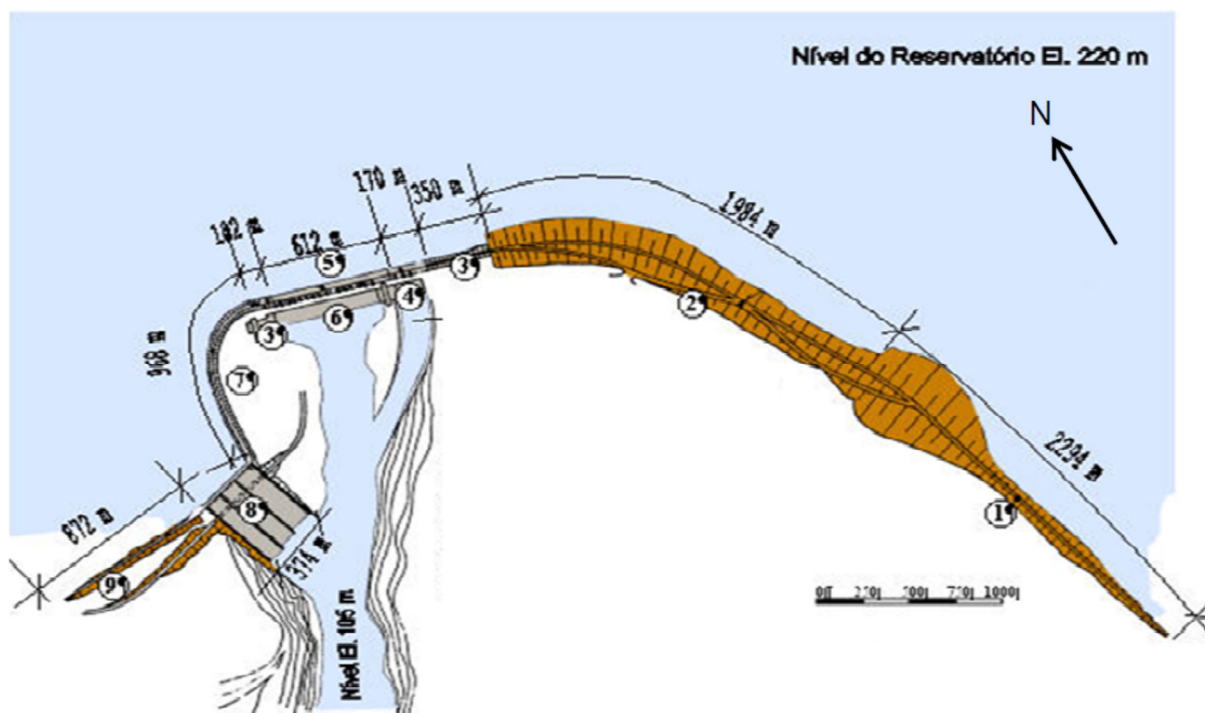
Configuração das estruturas da barragem de Itaipu (Itaipu Binacional, 2008)
